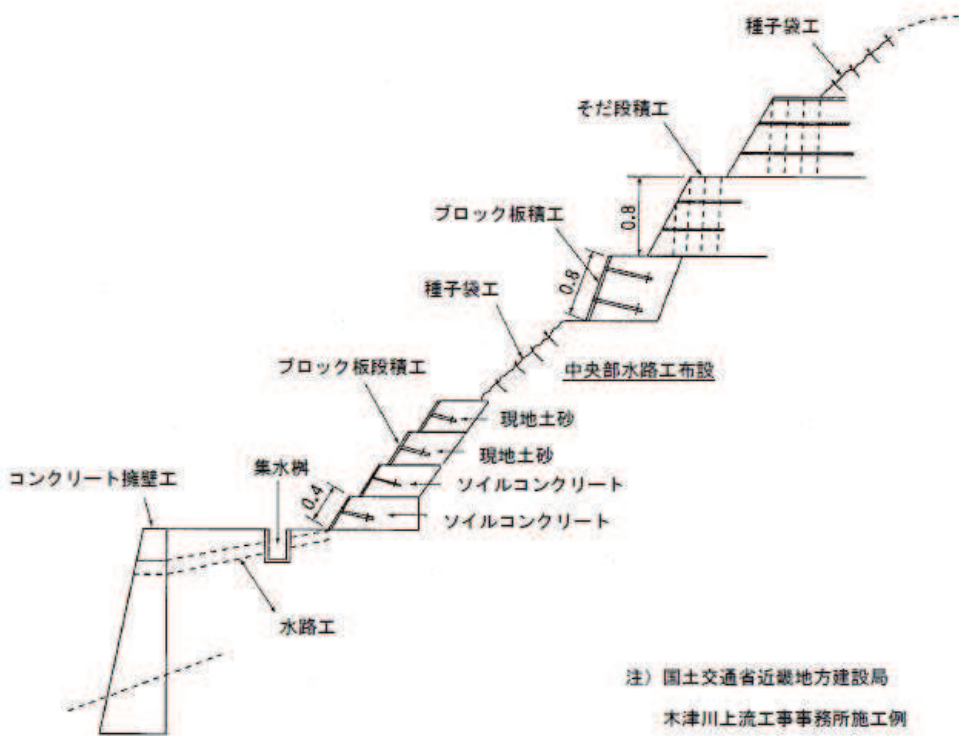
崩壊地 (施工例) 断面図 (単位: m)
